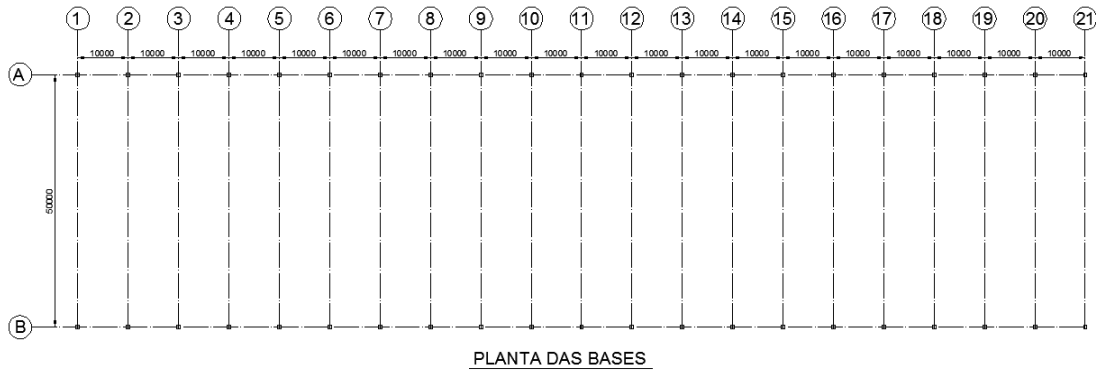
Planta das bases de concreto para estrutura da cobertura
